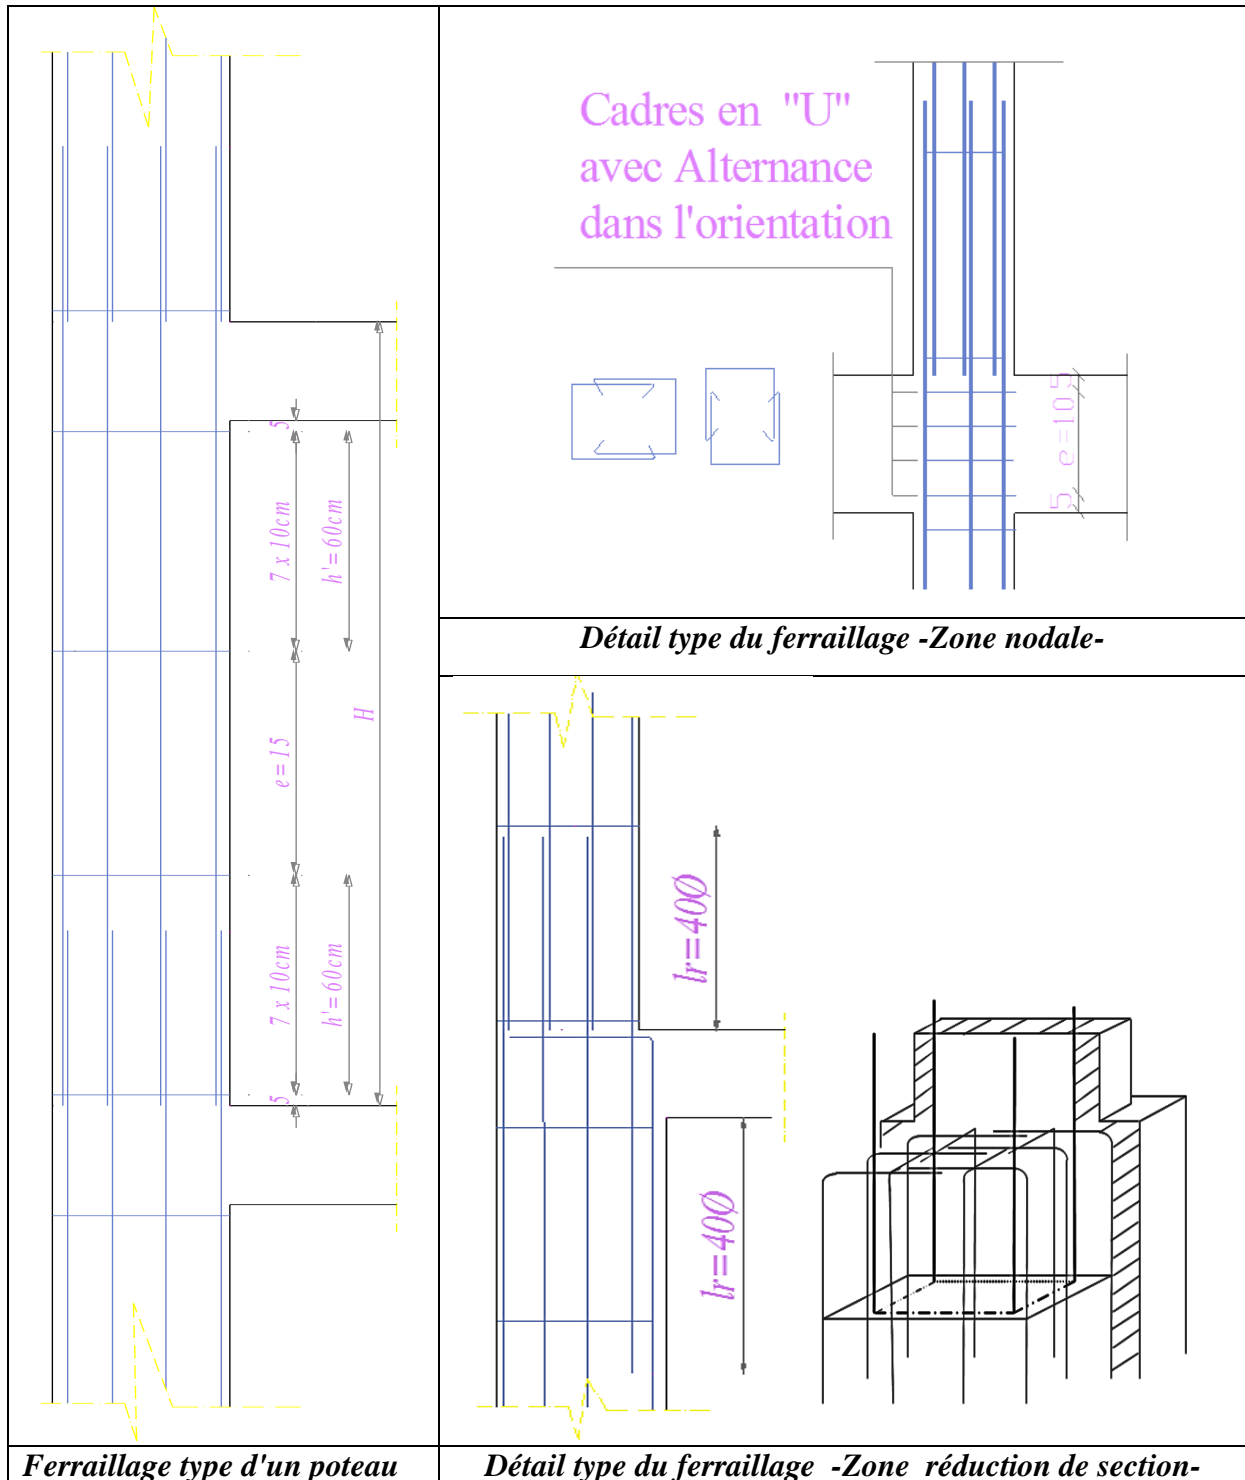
Ferrailage des poteaux (Coupe verticale)
